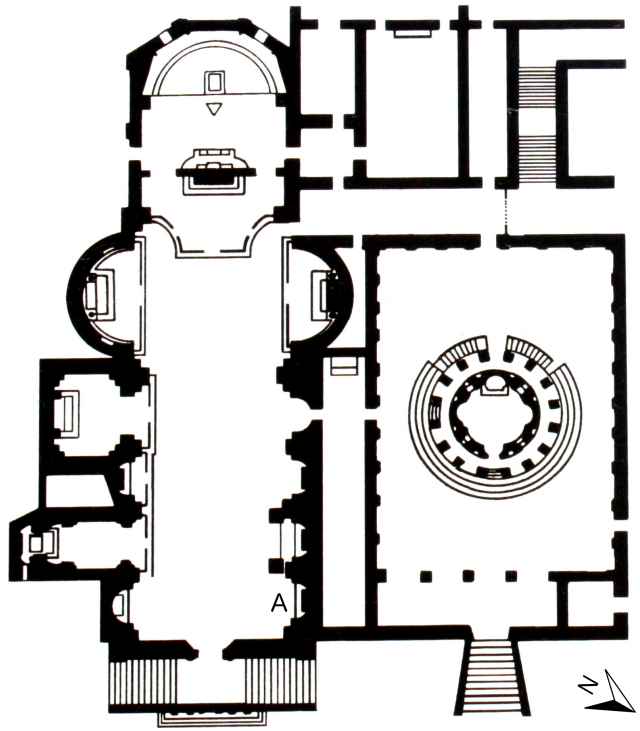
Grundriss der Kirche San Pietro in Montorio, Cappella Borgherini (A), nach CANTATORE 2007, S. 61.
